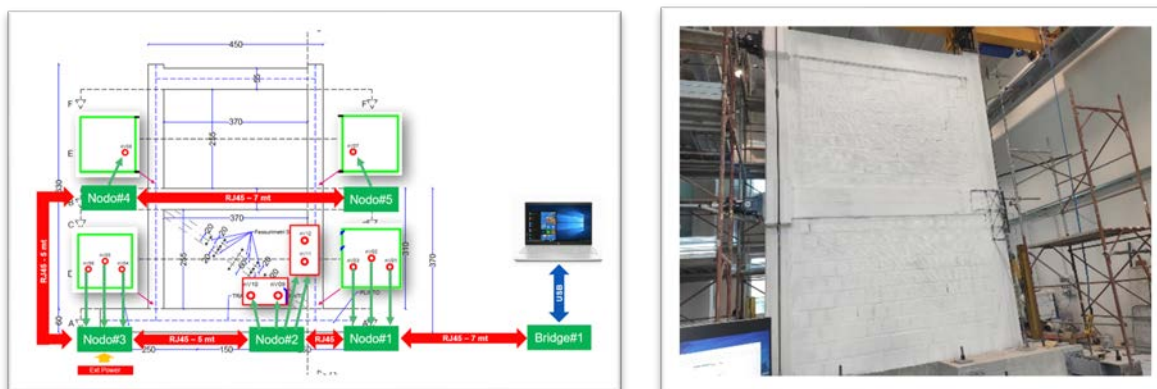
Schema e installazione del sistema di monitoraggio sul telaio in c. a. presso UniNA-San Giovanni a Teduccio.
